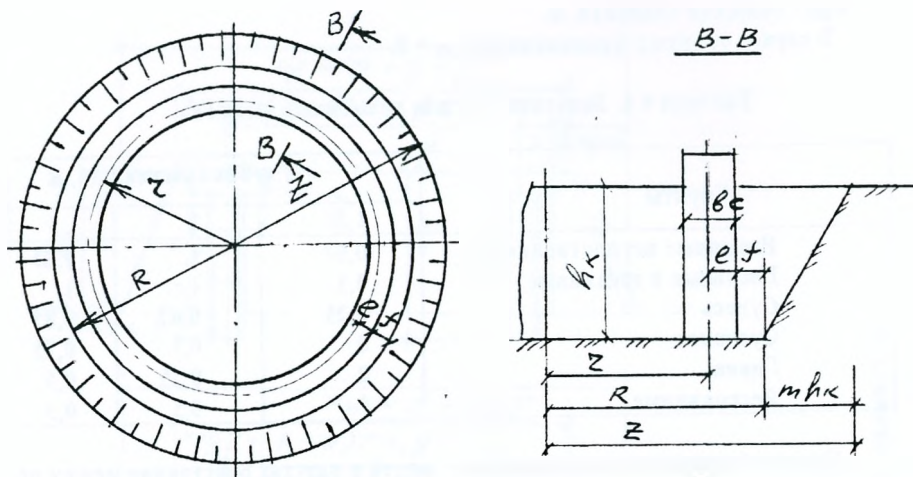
Схема котлована круглой формы со сборным фундаментом
